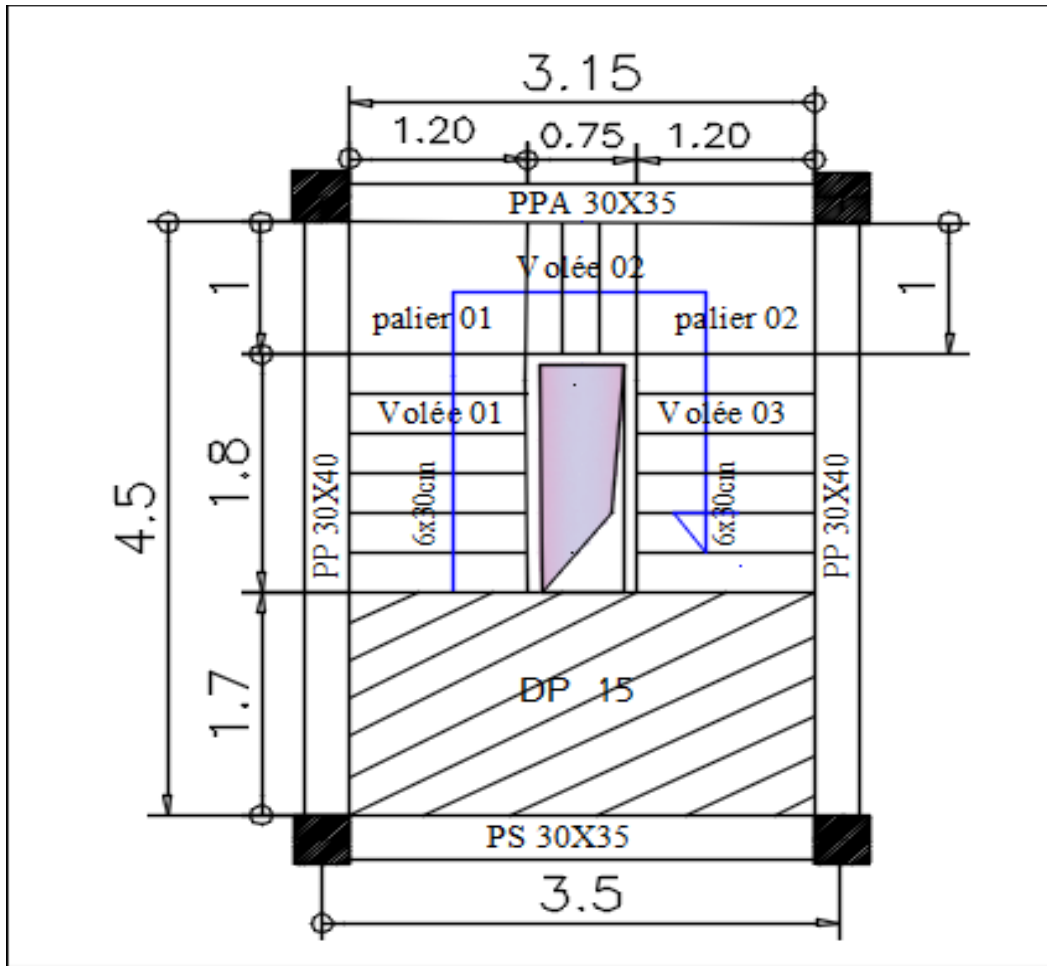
Vue en plan d'un escalier droit avec paliers intermédiaire.
